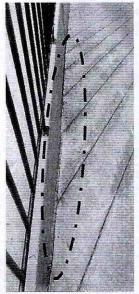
Grietas en escalera de acceso a parqueaderos del sótano
